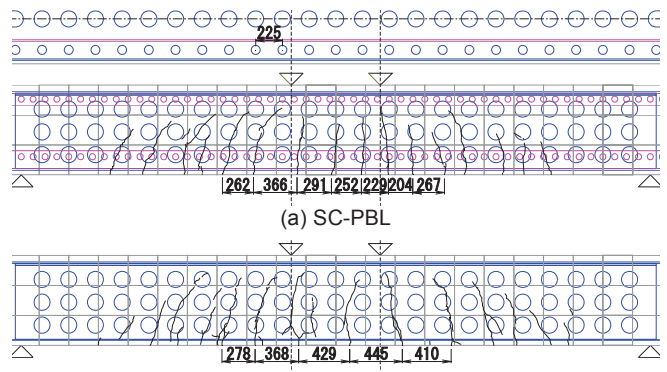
ひび割れ図 (Crack Pattern)
